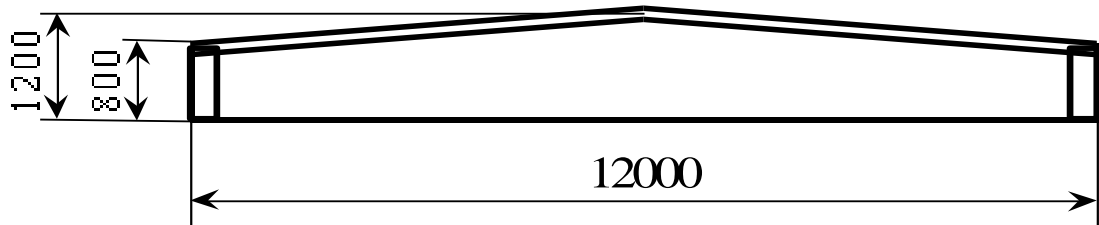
Залізобетонна балка скатних покрить
